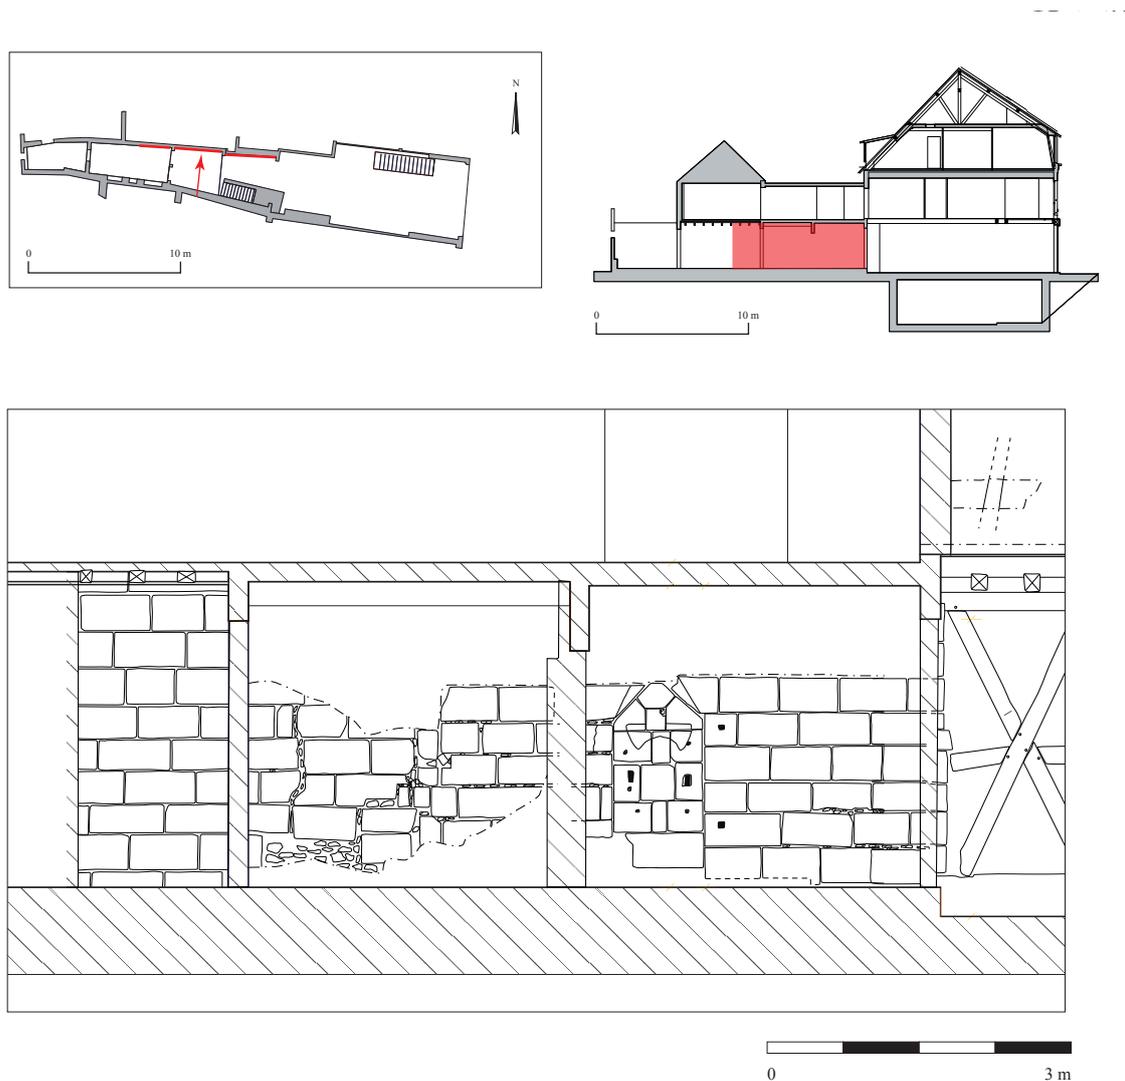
Elévation de la partie occidentale du mur nord au niveau du rez-de-chaussée avec le puits et le mur en pierre de taille (relevé S. Bryant, Inrap et A. Prévot, Inrap).
